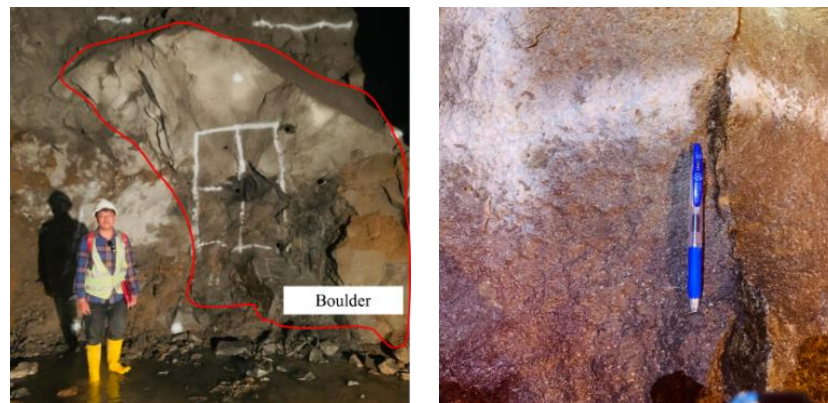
Kenampakan STA 288, 104 – 290,704 dengan Face tunnel yang tersusun litologi breksi laharik (kiri) dan wall segmen terdapat litologi breksi laharik terdapat *boulder
